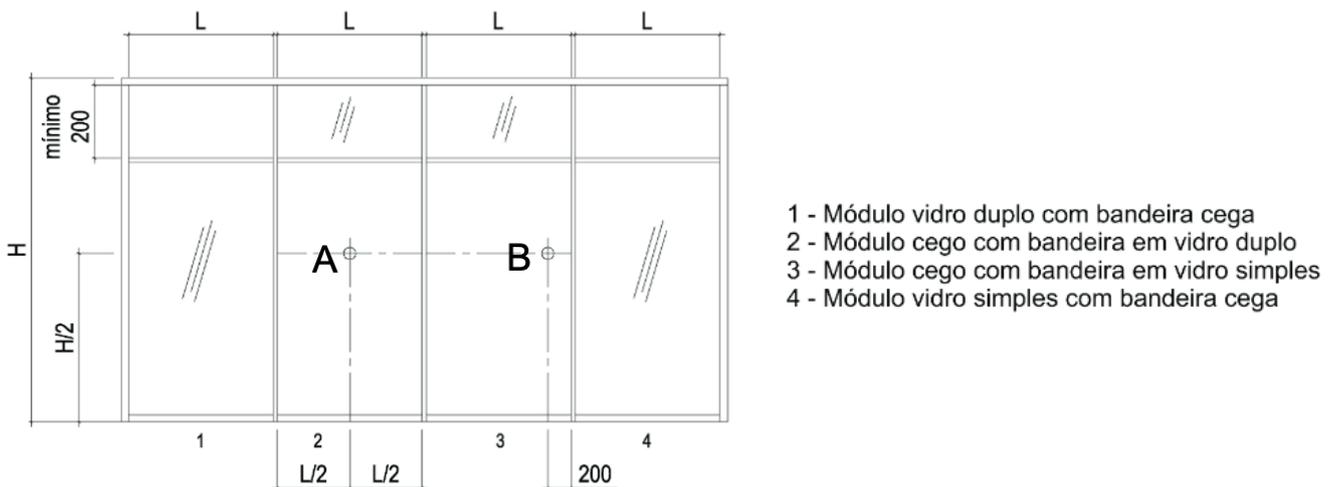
Configuração dos módulos e demonstração do local de aplicação do impacto
